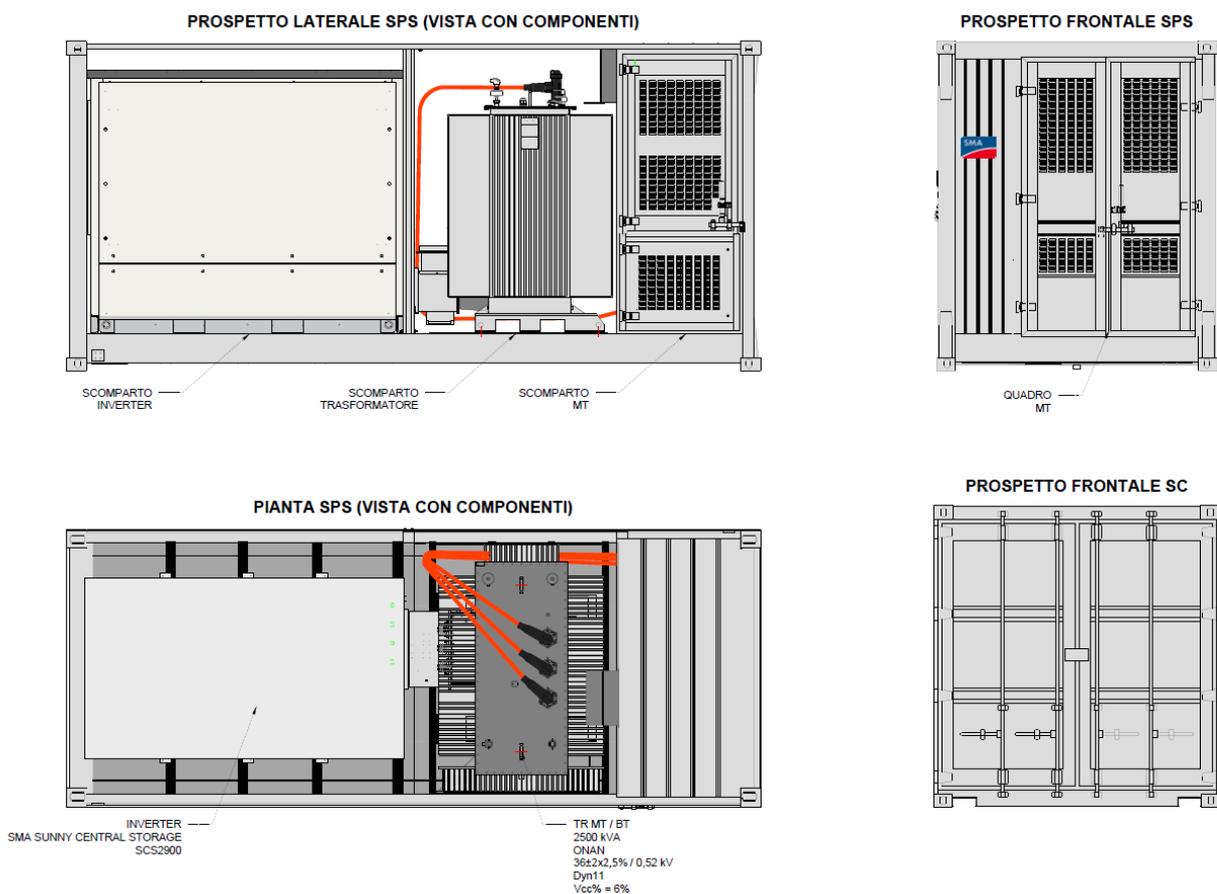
Pianta e Prospetto dello Storage Power Station con Storage Inverter
